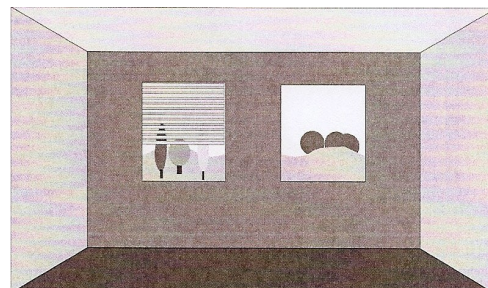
Installation d'un store à lamelles comme protection face à la source éblouissante
